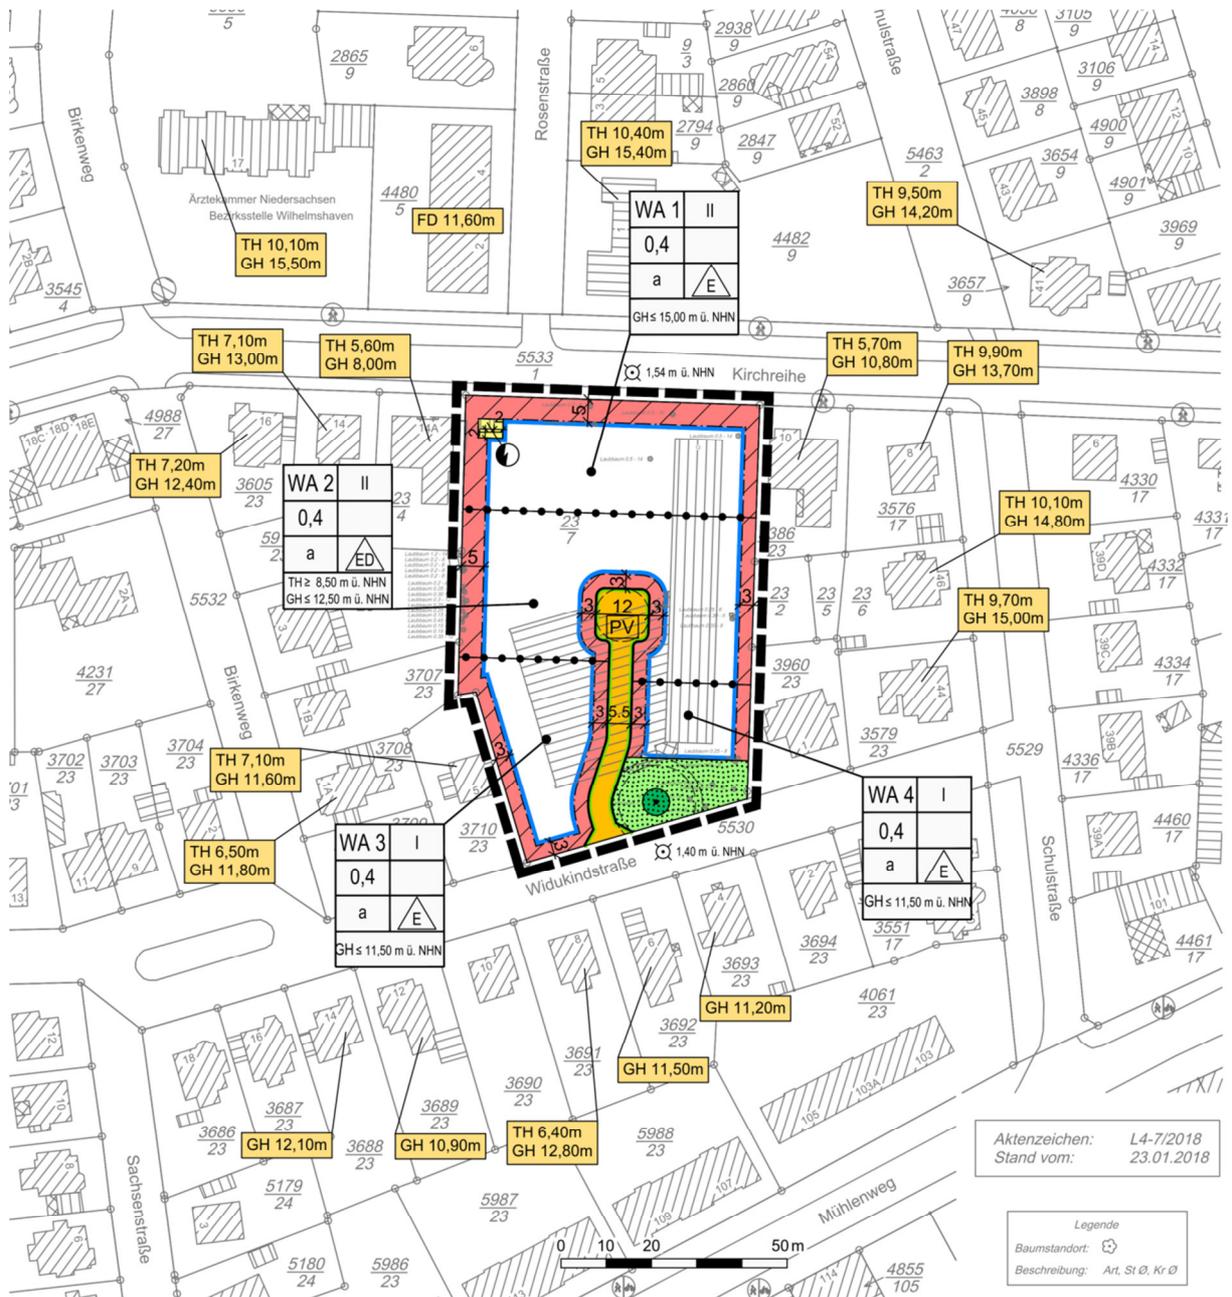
Vergleich Höhen Bestandsgebäude / Planungshöhen der Gebäude.
